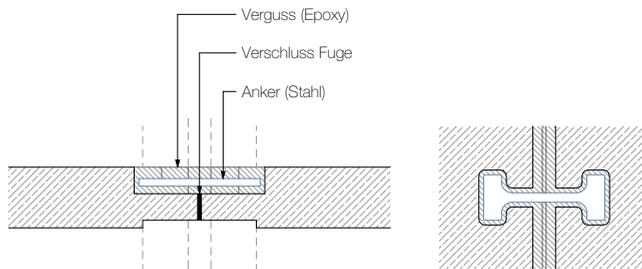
; Detail Modulverbindung horizontal, nass, 1:20
